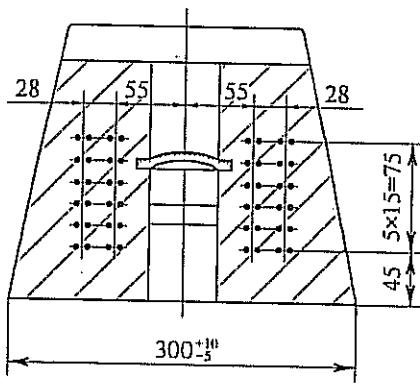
Сечения по железобетонному брусу (для железных дорог УЗ)
